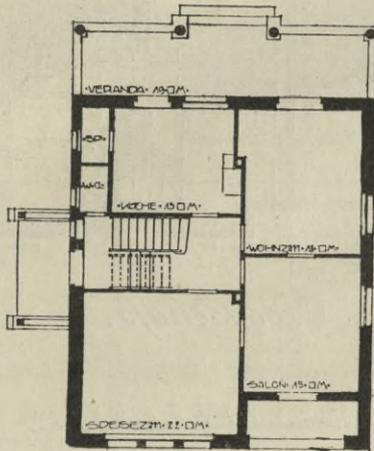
Landhaus Keil in Buchschlag, Erdgeschoß
